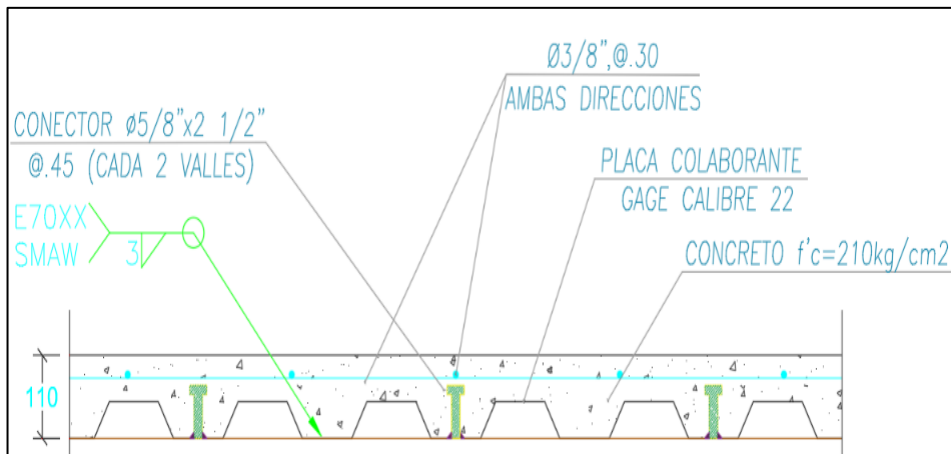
Conectores ubicados en la viga- Sistema estructural mixto.
